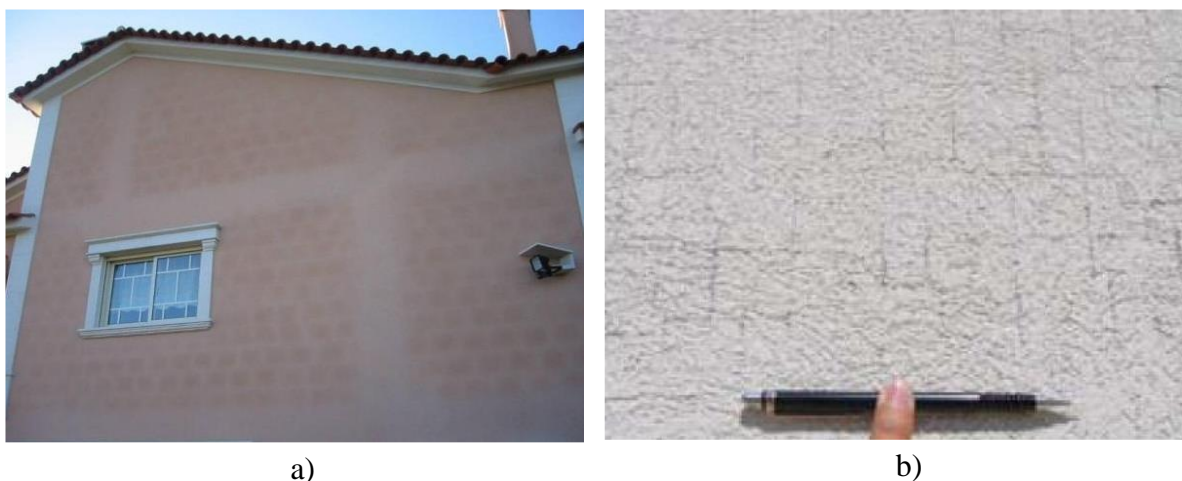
Patologias mais frequentes em rebocos monomassa: a) Visualização das juntas de argamassa e elementos estruturais; b) Fissuração (Amaral, 2013)
